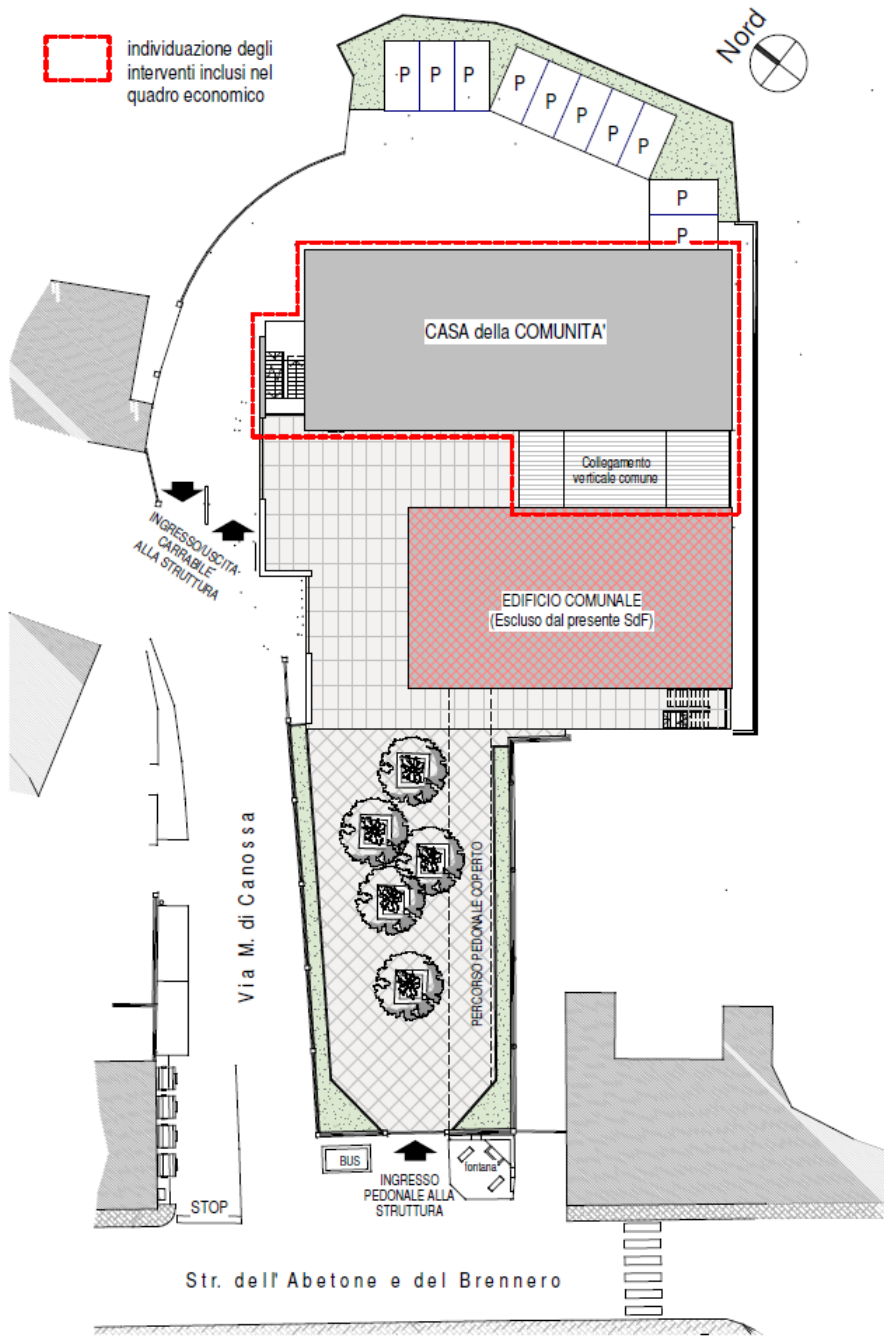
Planimetria di inquadramento - ipotesi di progetto
